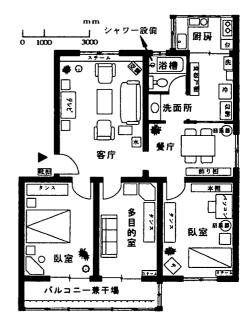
調査対象住宅の平面図 (タイプ2約98 m²)
